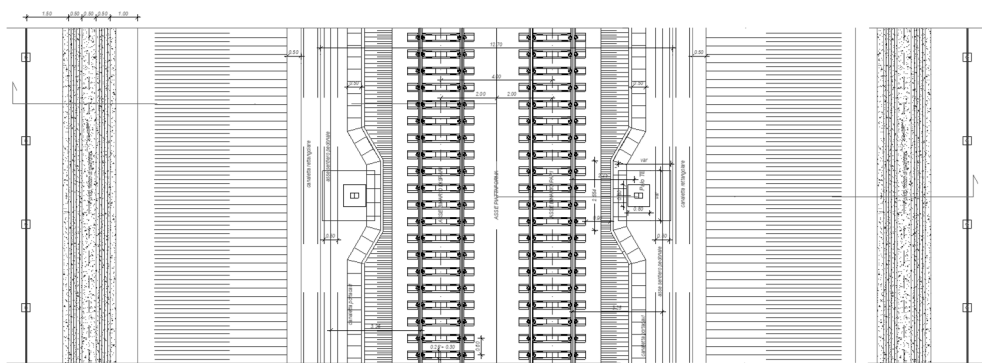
Stralcio planimetrico con sezione tipo ferroviaria in trincea a doppio binario in rettilineo
